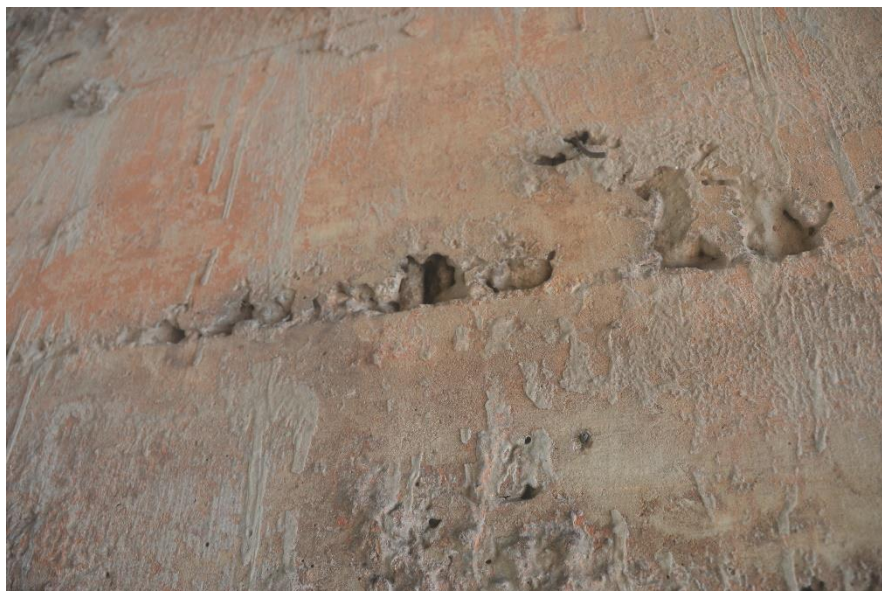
Falha de Concretagem no Cortina Central Norte – Viaduto W –11/12 Norte.
